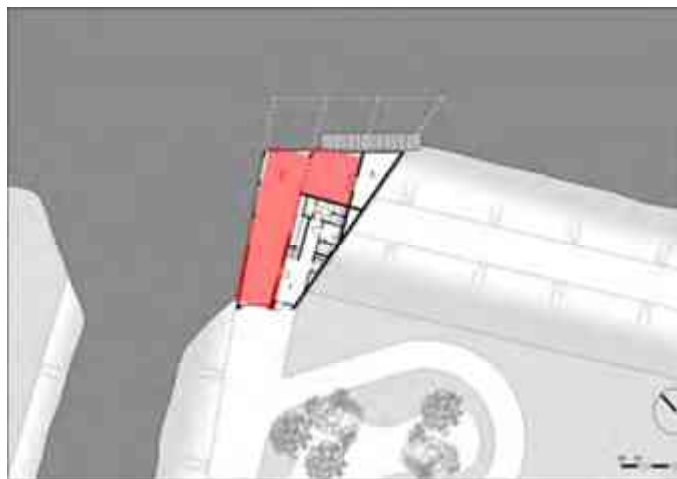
Planta baja del Centro Educativo Natural de Oostvaarders.
